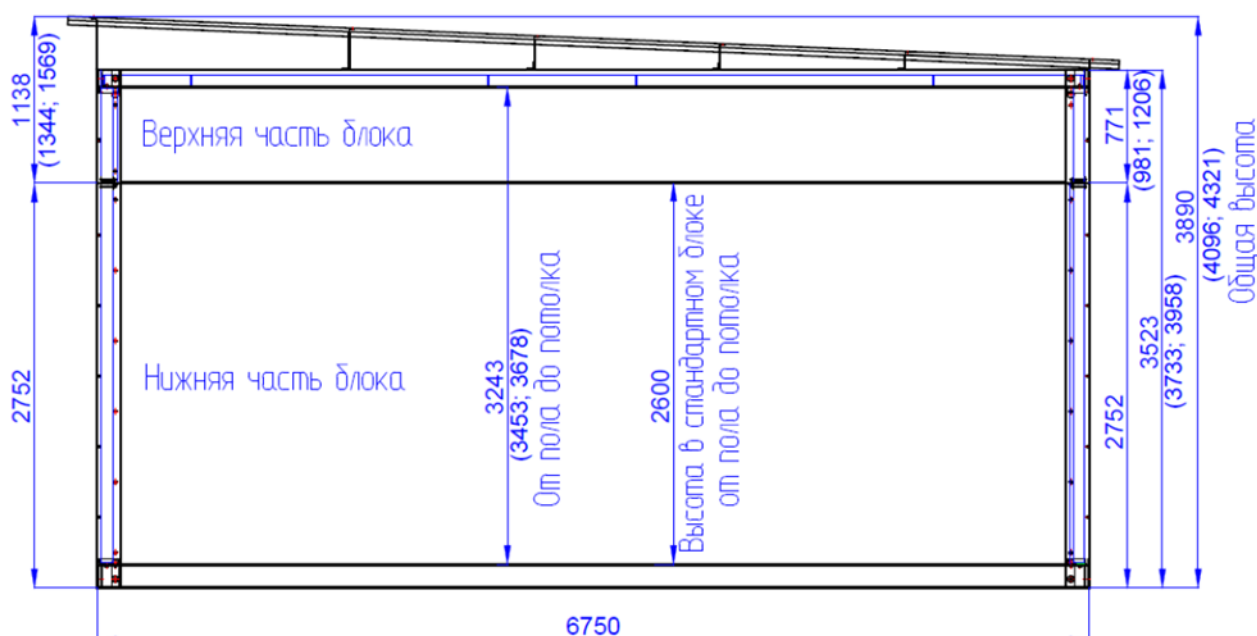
Габаритные размеры модуля с увеличенной высотой
